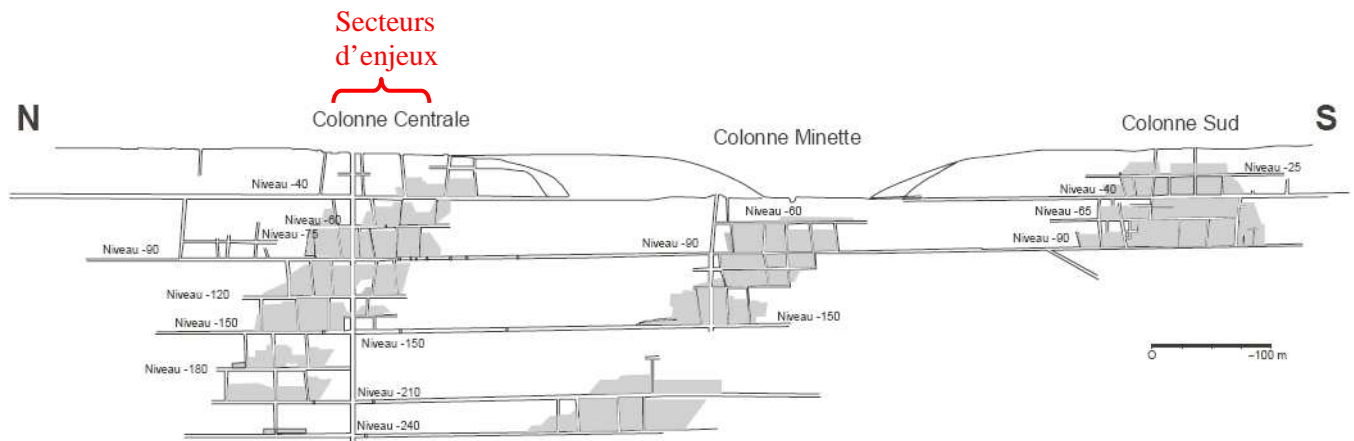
Coupe schématique longitudinale des travaux souterrains
